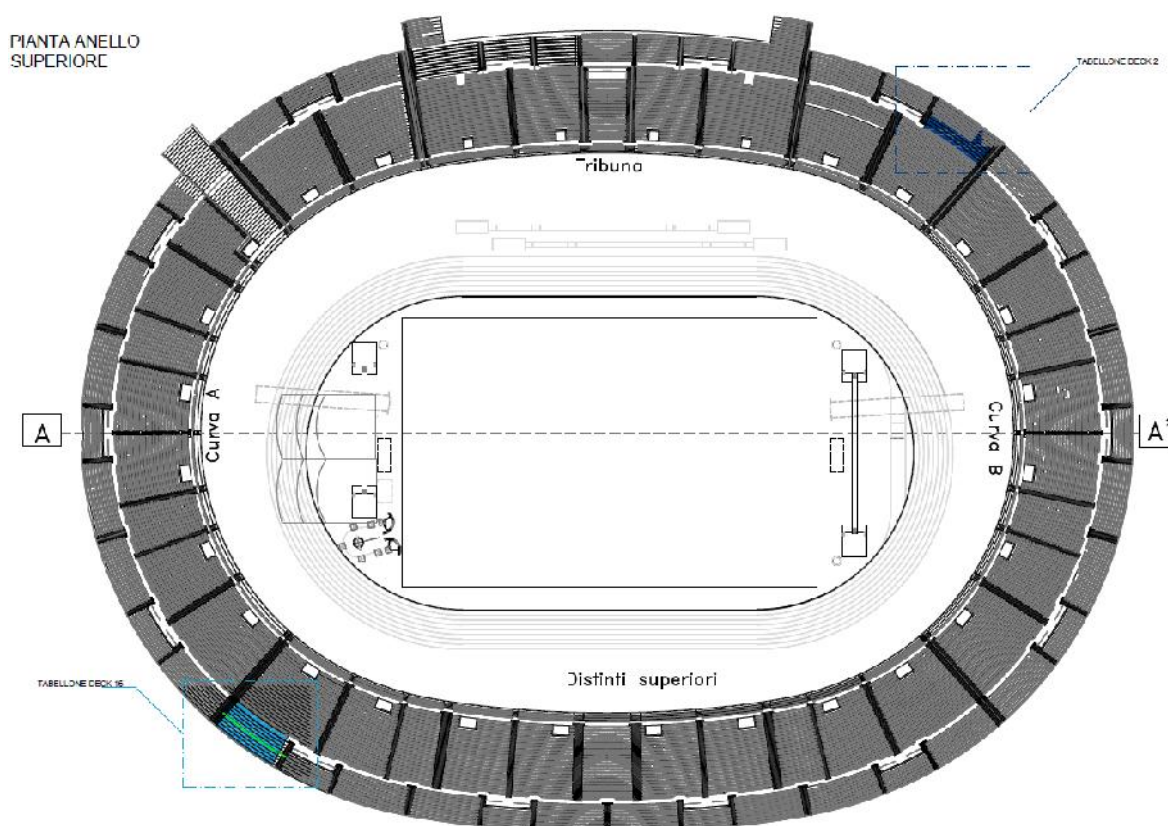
Individuazione della collocazione dei LED WALL 1 e 2.
